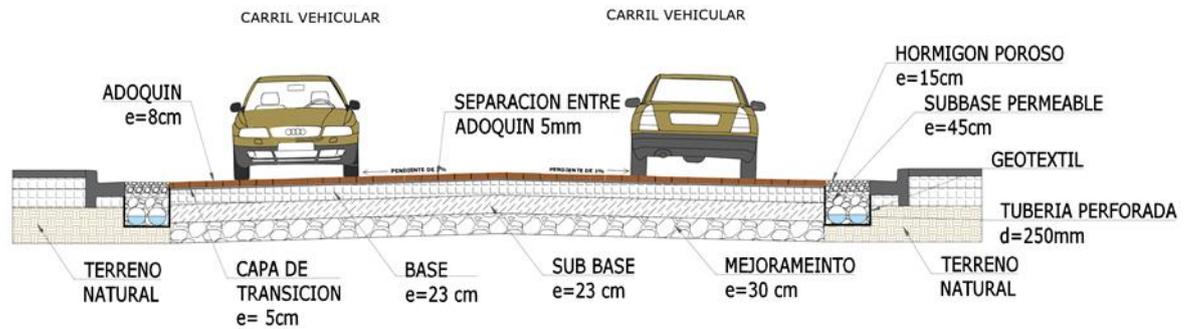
Sección de propuesta de diseño de pavimento permeable
